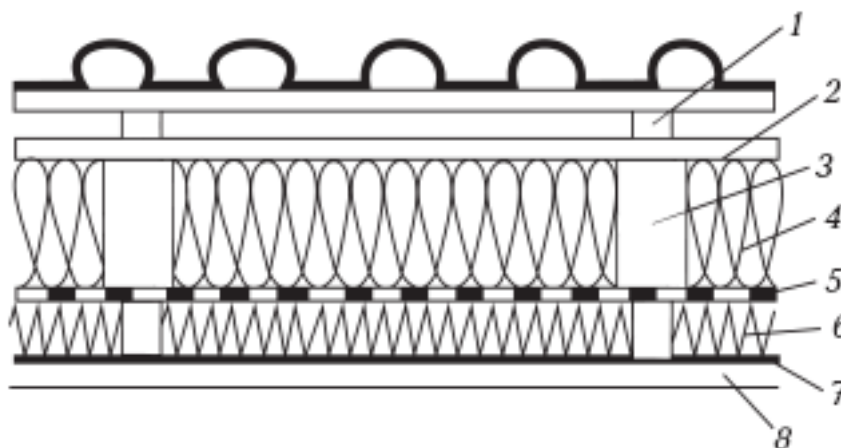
Двухслойная теплоизоляция крыши: 1 – контрообрешетка; 2 – подкровельная гидроизоляция; 3 – стропило; 4 – первый слой теплоизоляции; 5 – паронепроницаемая пленка; 6 – второй слой теплоизоляции; 7 – дополнительная обрешетка; 8 – облицовка (ГКЛ)
